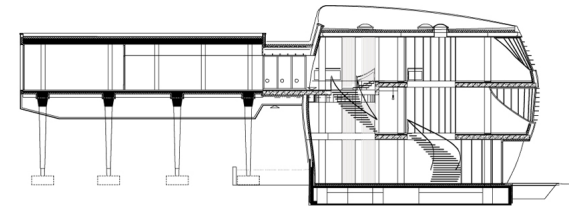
Sezione trasversale; Fonte: C. Piferi, 2010;
